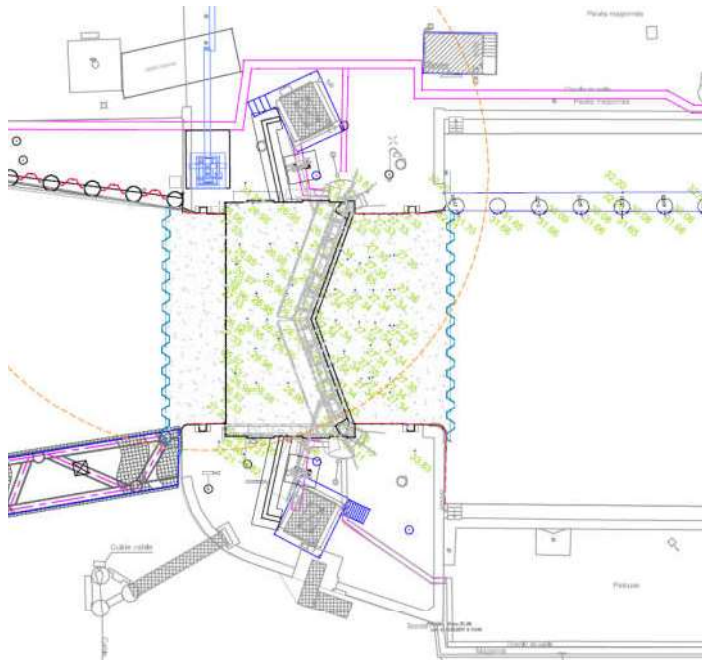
Vue en plan de la tête amont après travaux (DOE travaux 2021-2022)
